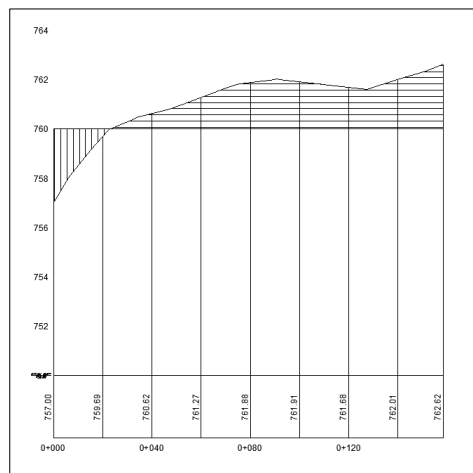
Rencana Elevasi Area 1 Potongan Memanjang Demnas
